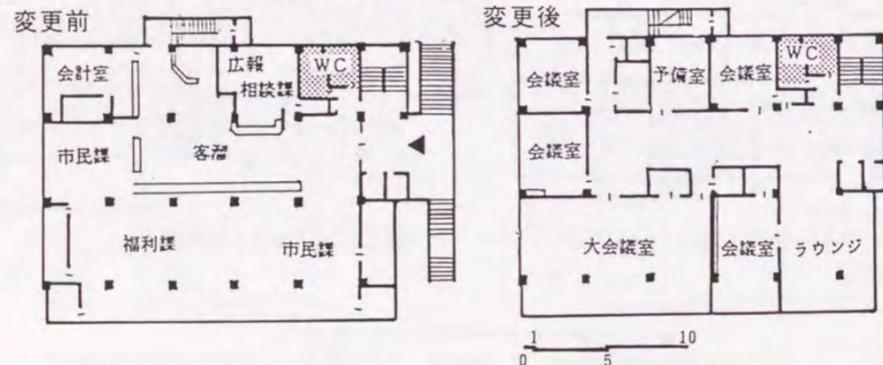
<5>神戸市葺合地区センター(旧区役所)2階平面図
